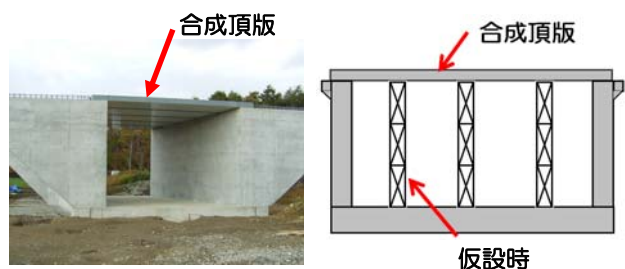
頂版施工完了時 図 I-1 函渠工断面図
